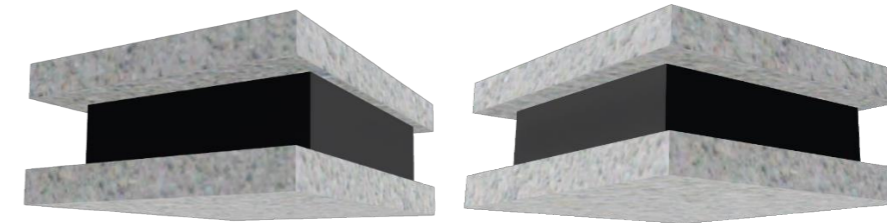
Neoprenos en estribo (izquierda) y pilas (derecha)
